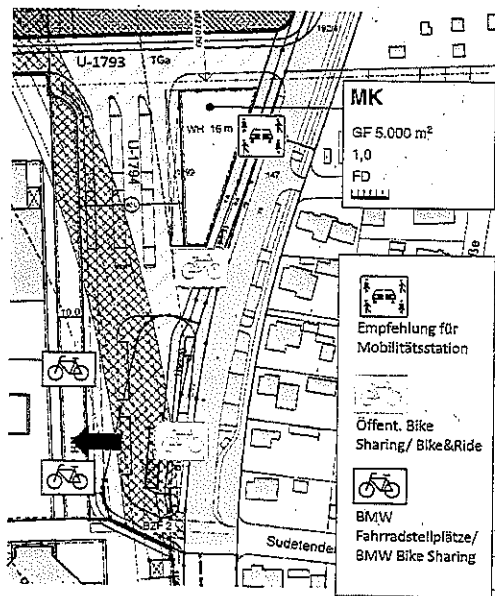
mögliche Platzierung Fahrradabstellanlagen (maßstabslos)
